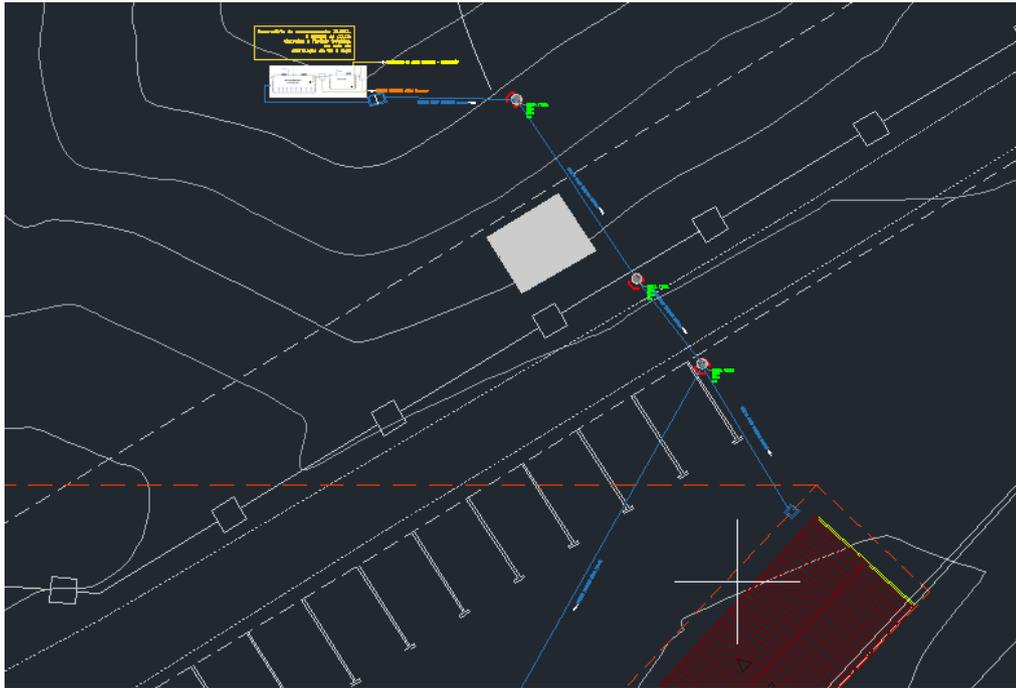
Sistema de recolha e armazenamento (25 m<sup>3</sup>) das águas pluviais a instalar no Clubhouse e Armazém logístico/garagem de apoio
